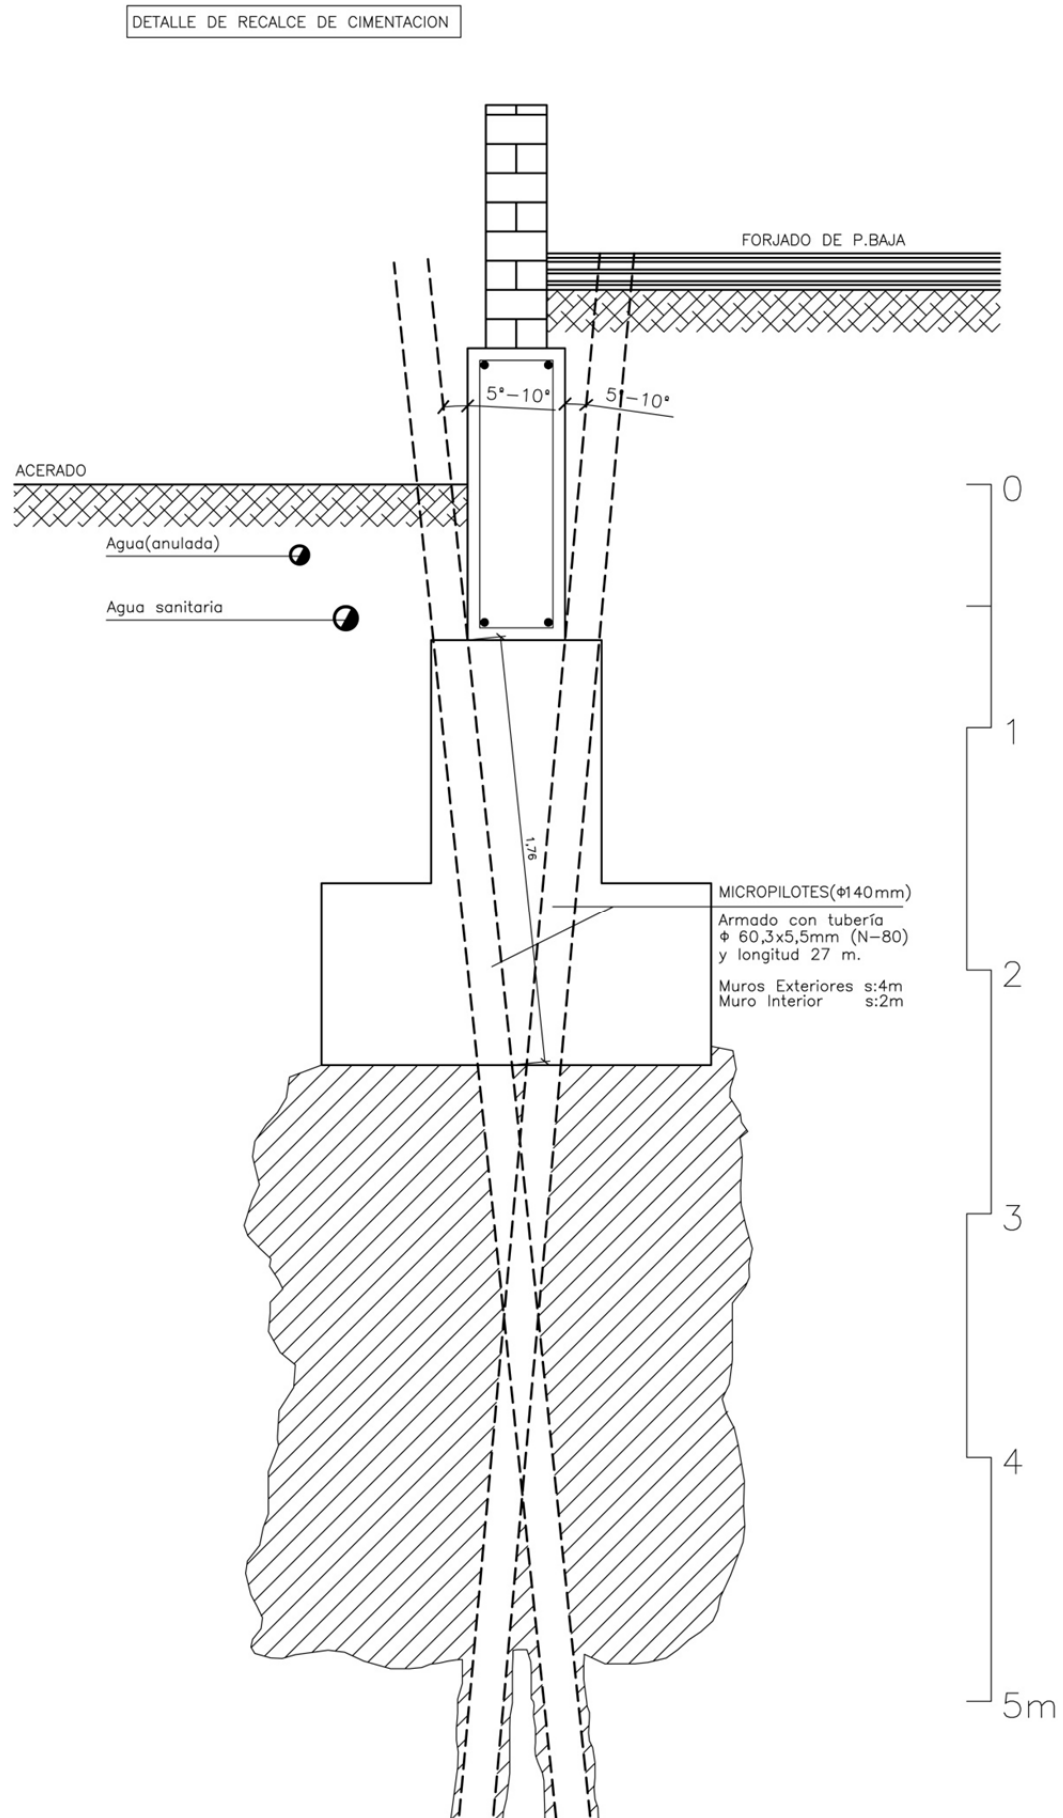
Detalle del recalce de la cimentación. Fuente: Vicerrectorado de Infraestructuras.
